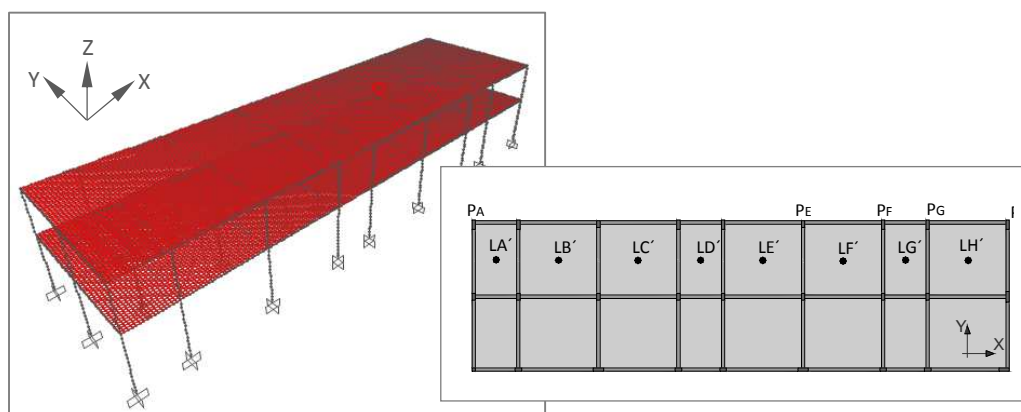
Planta da estrutura global tipo “B” e respetivo modelo de elementos finitos
